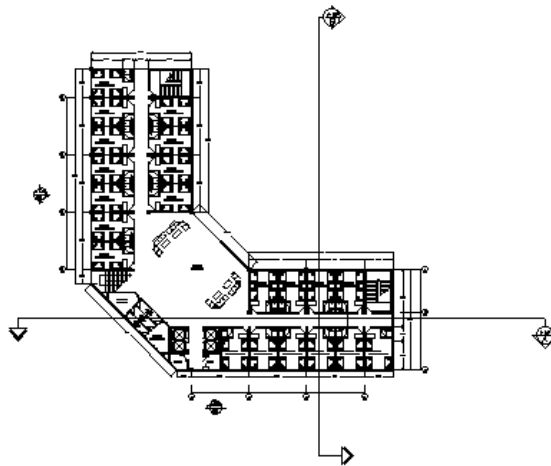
Denah Lt. Dasar Gedung B
